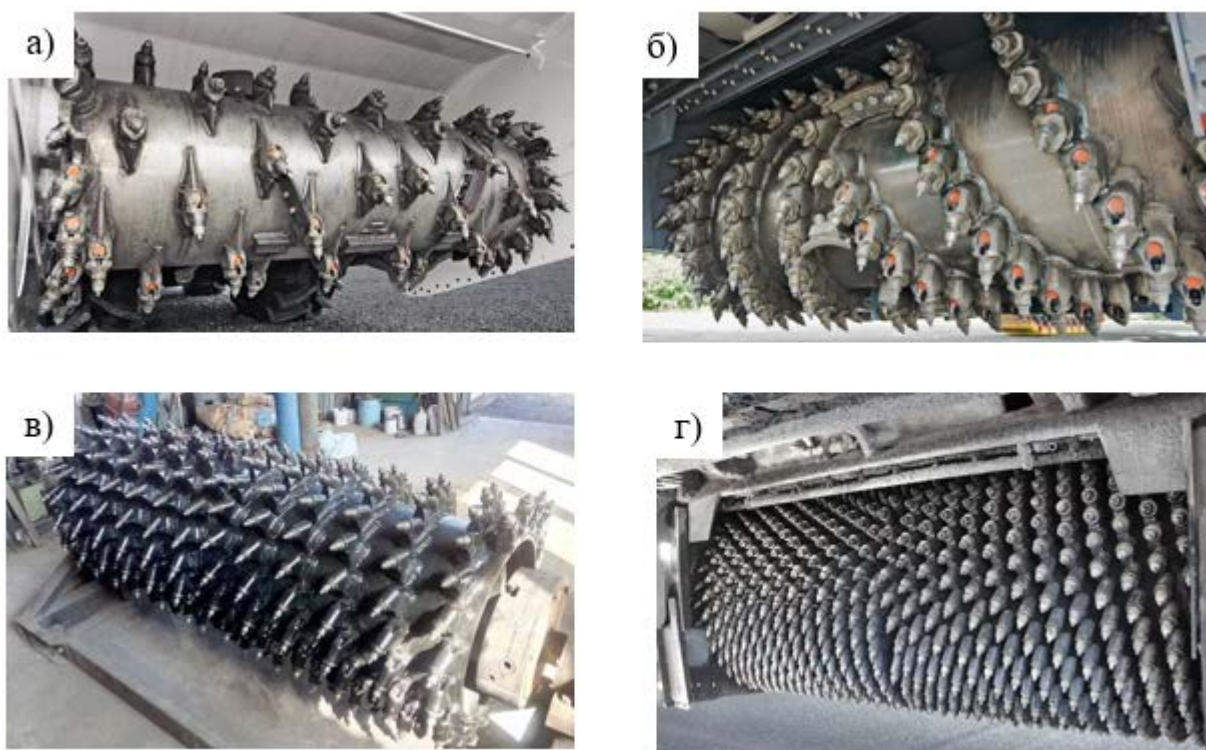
Виды фрезерных барабанов: а – черновой барабан, б – стандартный фрезерный барабан, в – чистовой барабан, г – микрофрезерный барабан
